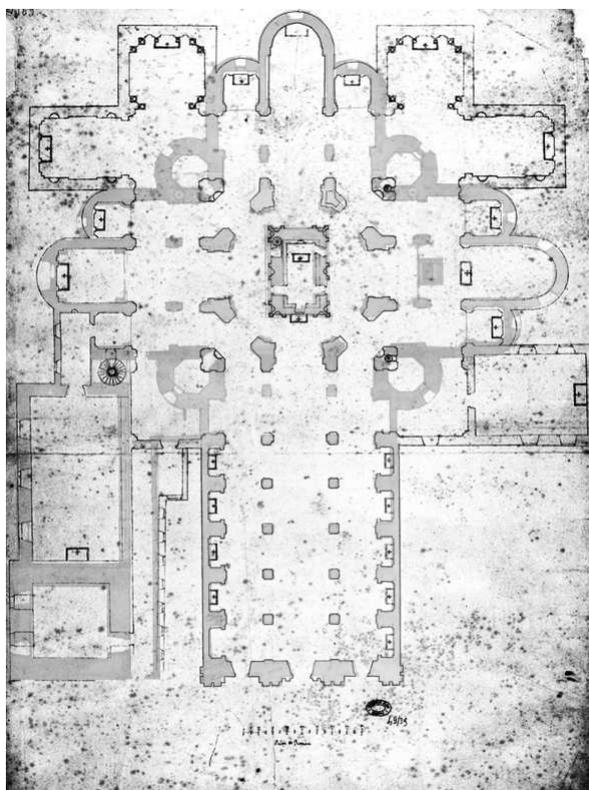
Sovrapposizione della pianta conservata a Parma (ASPr, Raccolta Mappe e disegni, Vol. 49, f. 39) alla parte corrispondente di un disegno della chiesa di Loreto conservato nell'Archivio Storico della Santa Casa (ASSC, senza collocazione, cfr. nota 81). Le parti contornate di nero sono relative al disegno qui discusso.
